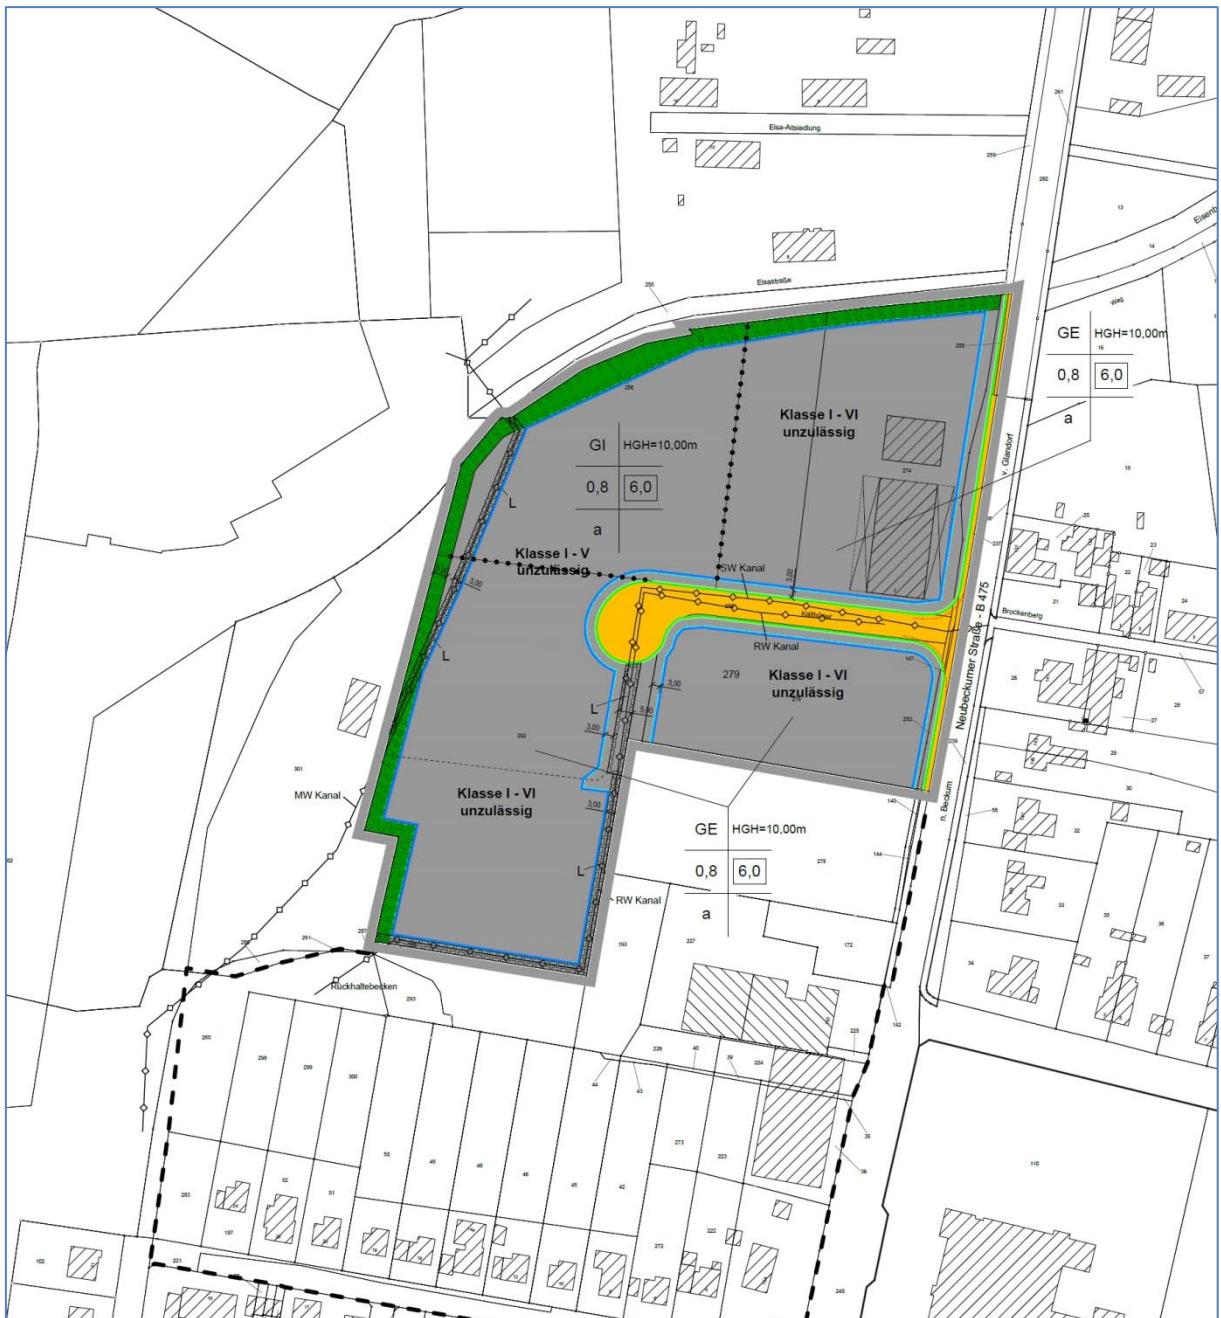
Geplante Leitungstrassen (Detail der 1. Planänderung zum Bebauungsplan Nr. 38)
